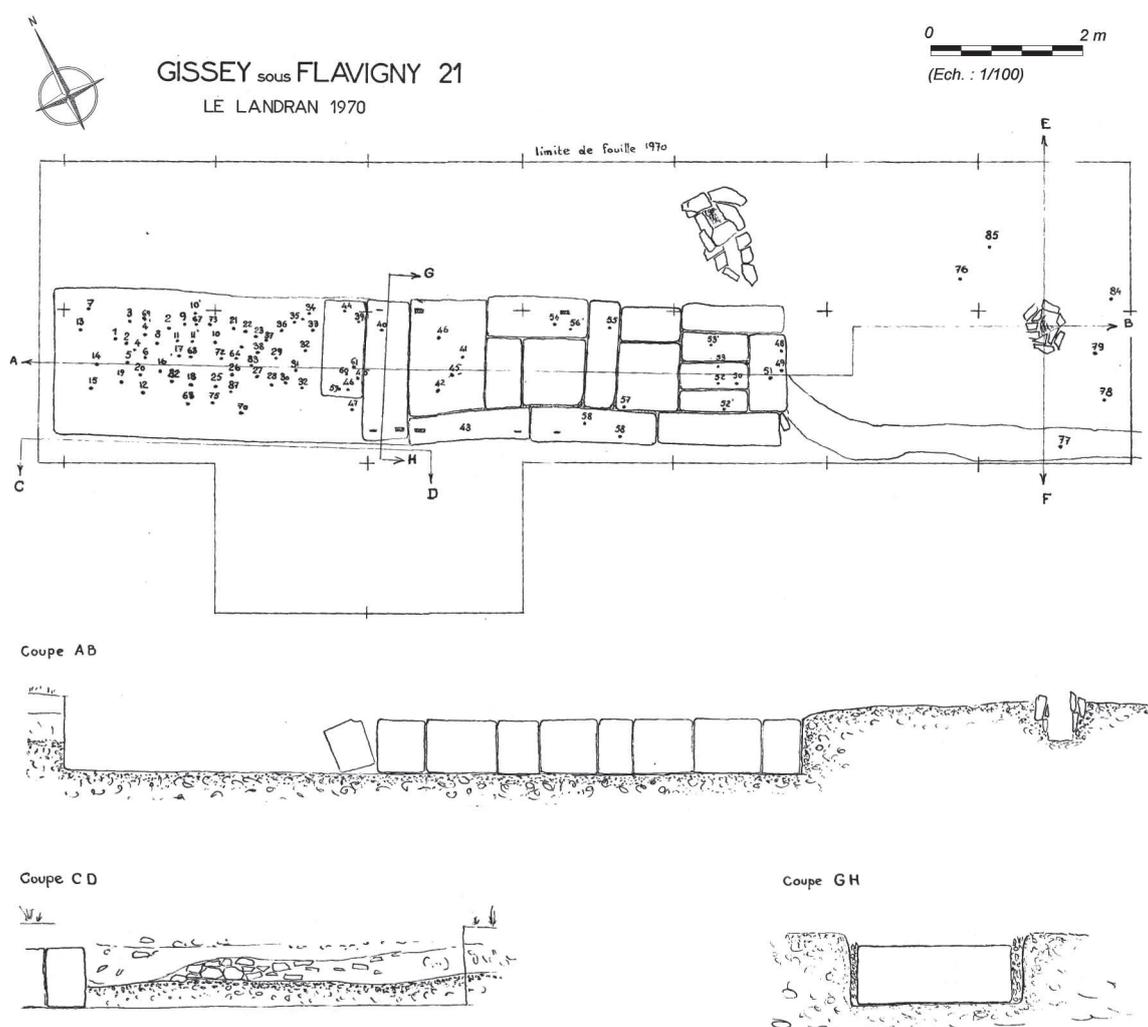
Plan et coupes du massif de fondation fouillé en 1970. Dessin J. Guéritte.
